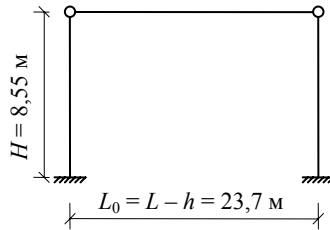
Расчётная схема поперечной рамы к примеру 1
